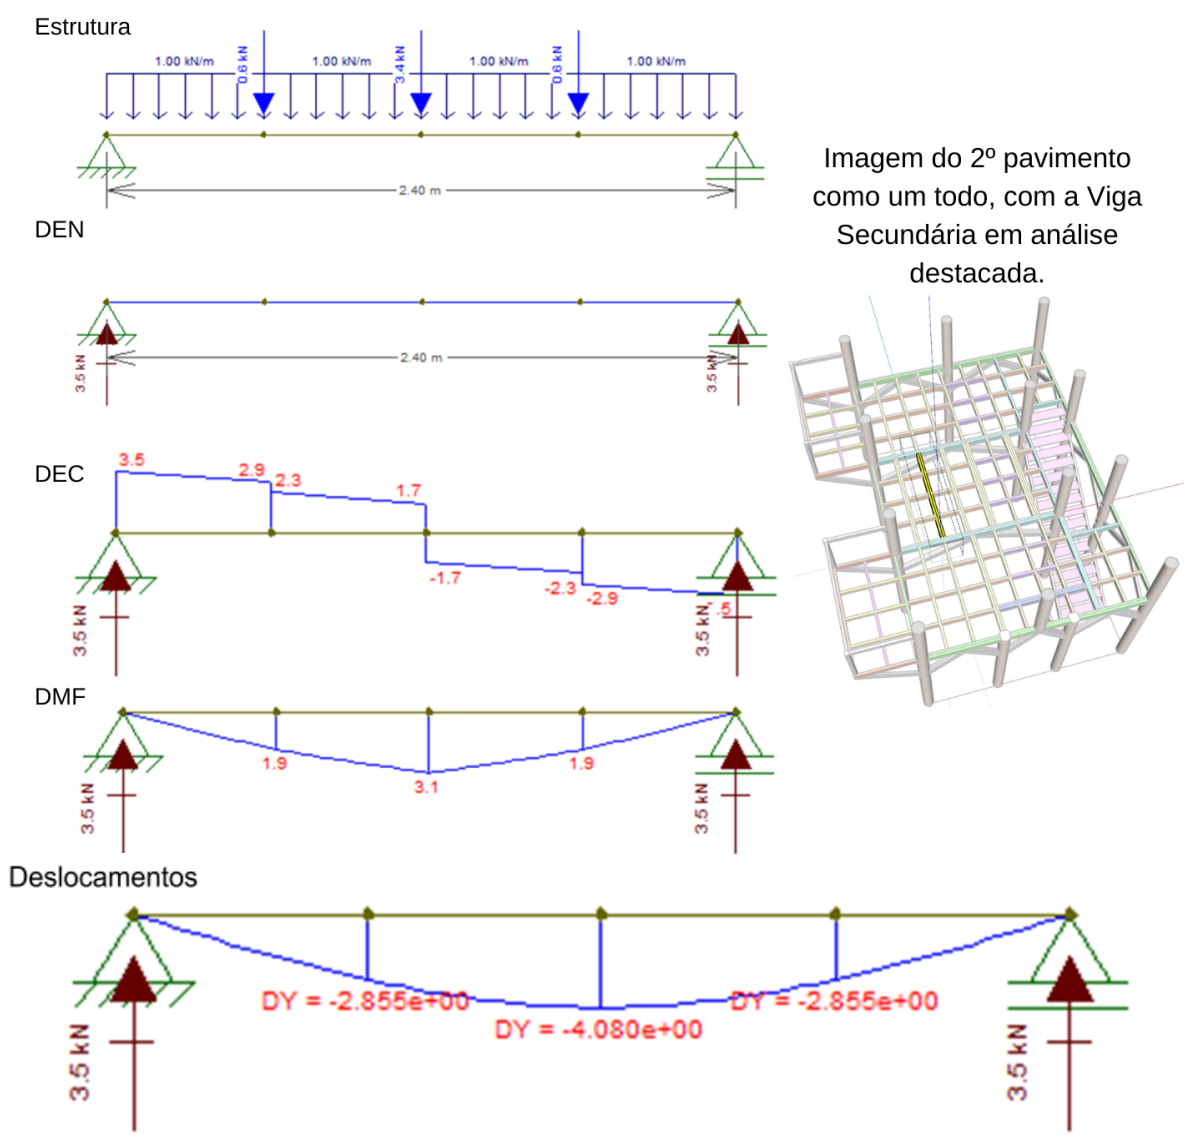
Esquema e análises estruturais das vigas secundárias presentes nos recortes da escada
